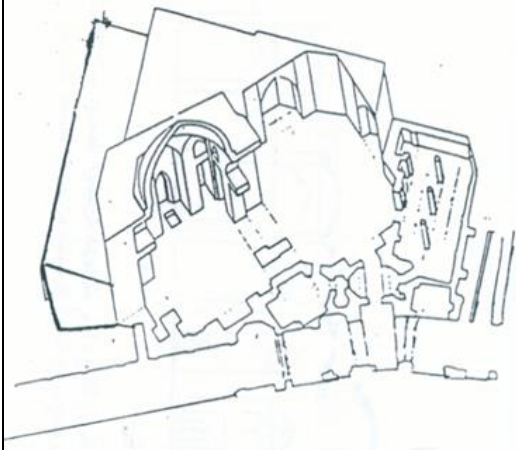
مسقط أفقي لكنيس حاج أليهوره
